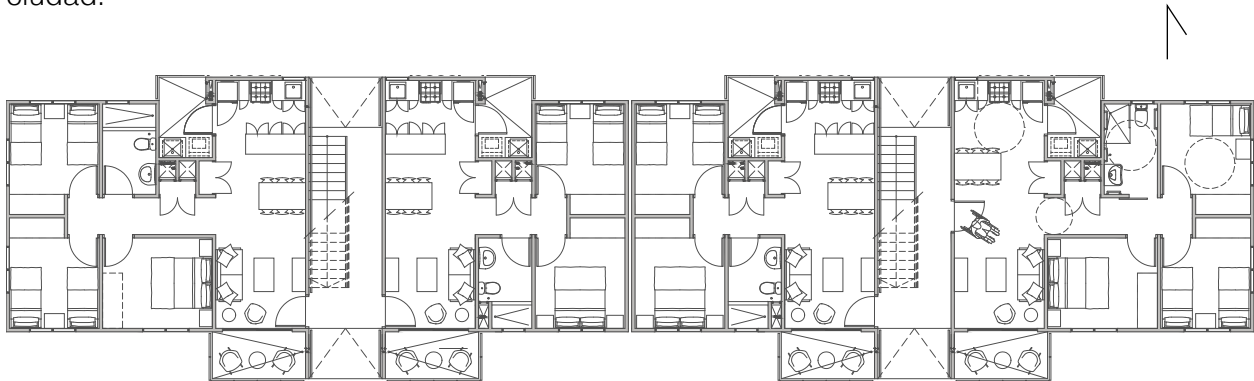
Planta Baja, La Barquita, Santo Domingo.
